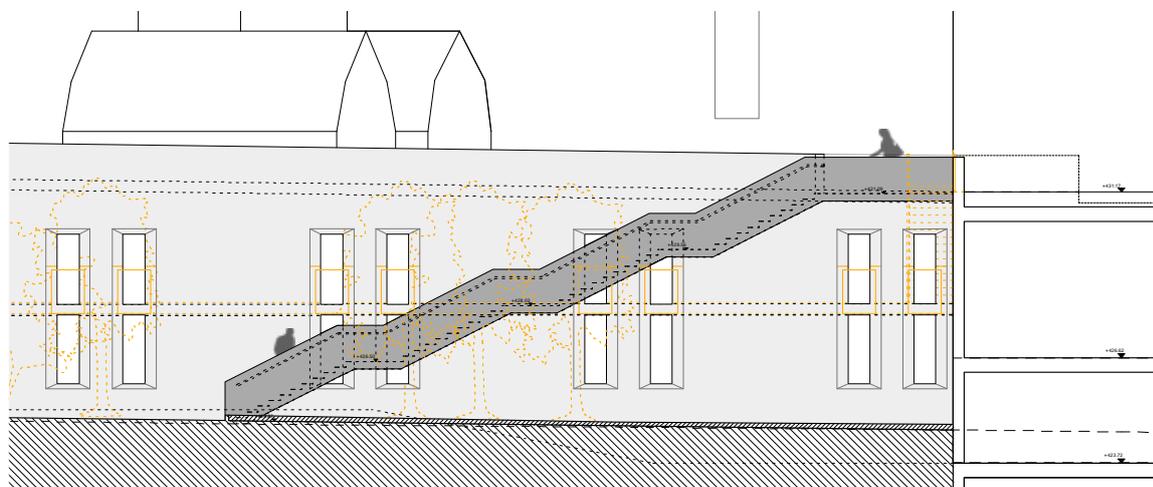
Accès Nord-Est _ élévation _ échelle : 1/200
